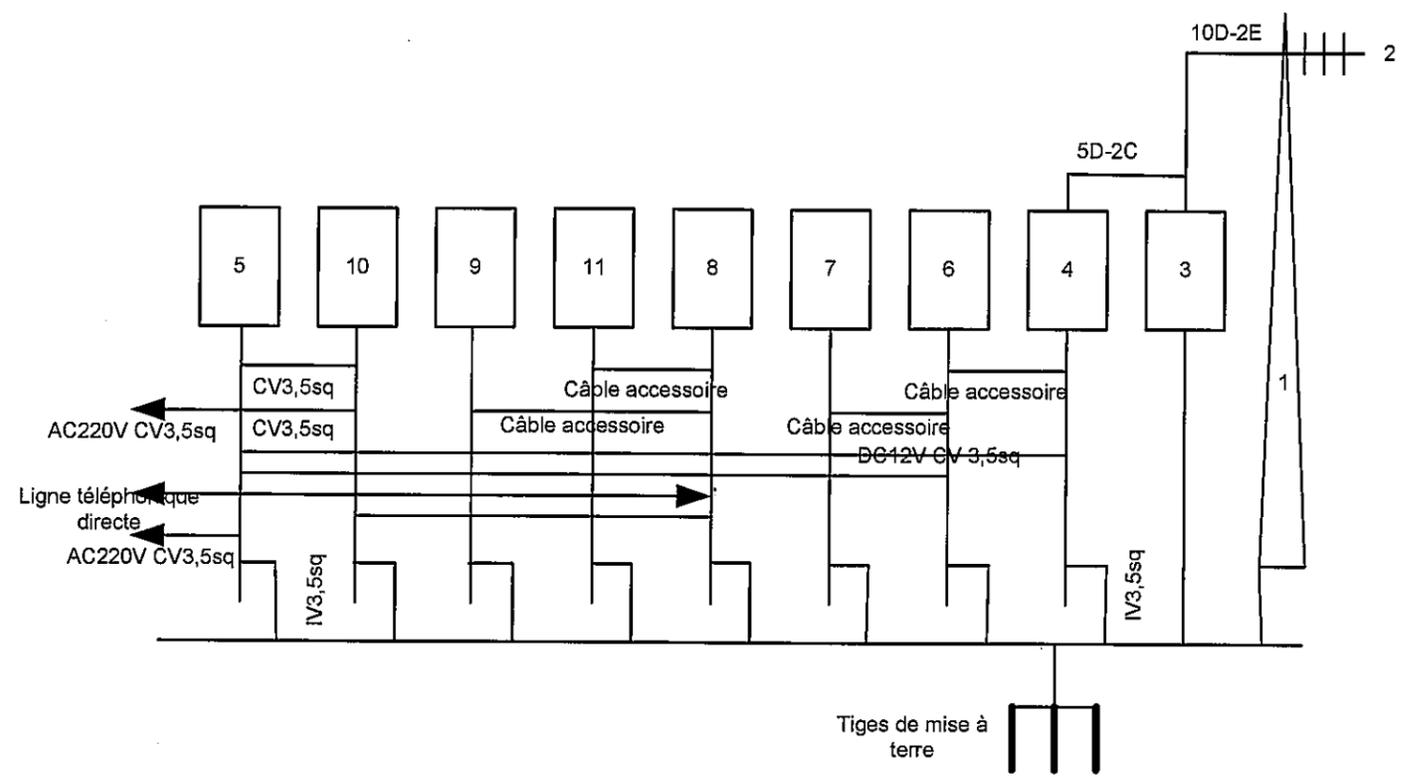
PLAN D'AMENAGEMENT DES EQUIPEMENTS
